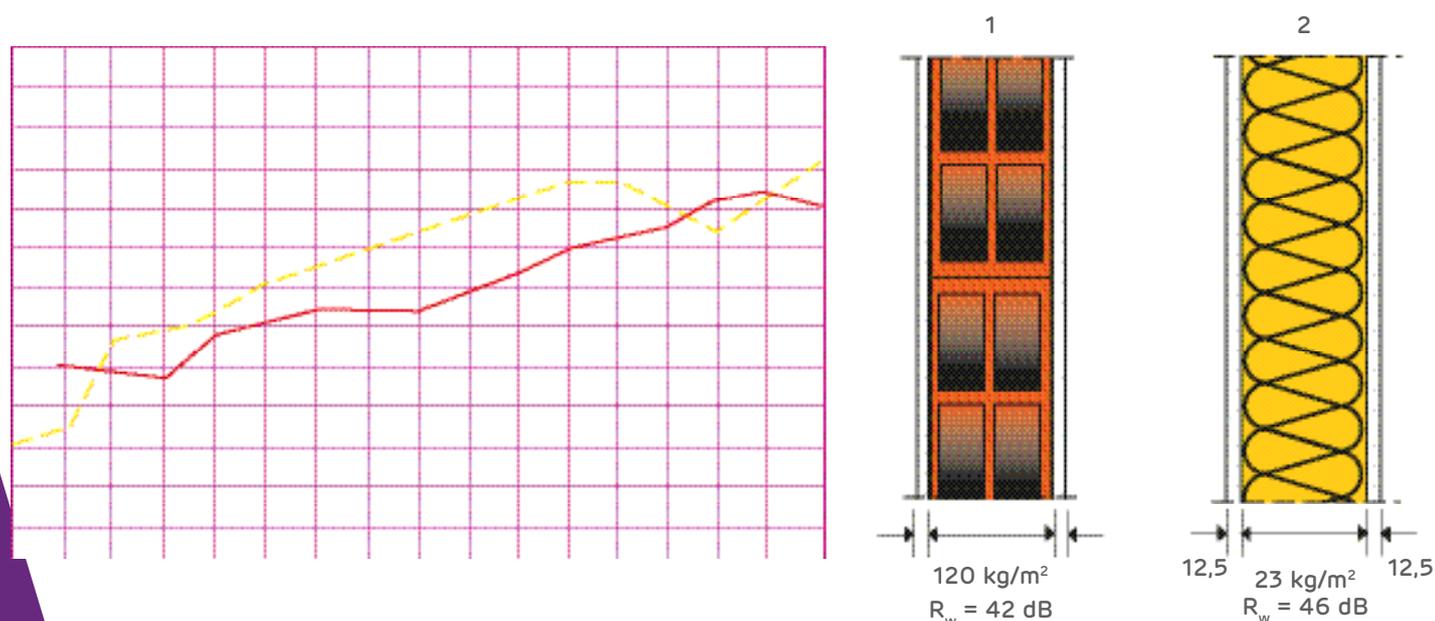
Confronto tra il potere fonoisolante di una parete in muratura e di un divisorio di lastre in gesso rivestito
